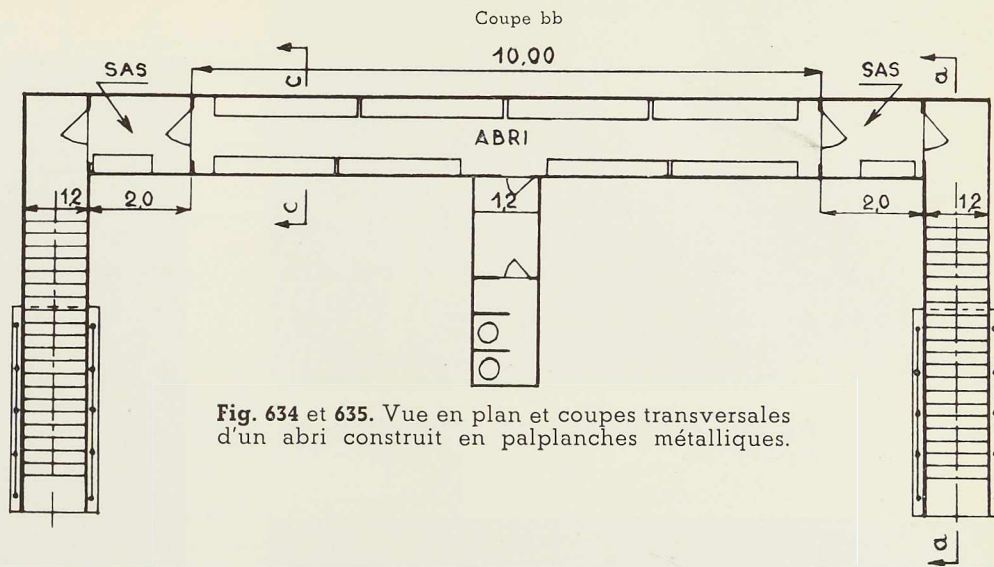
et 635. Vue en plan et coupes transversales d'un abri construit en palplanches métalliques.
